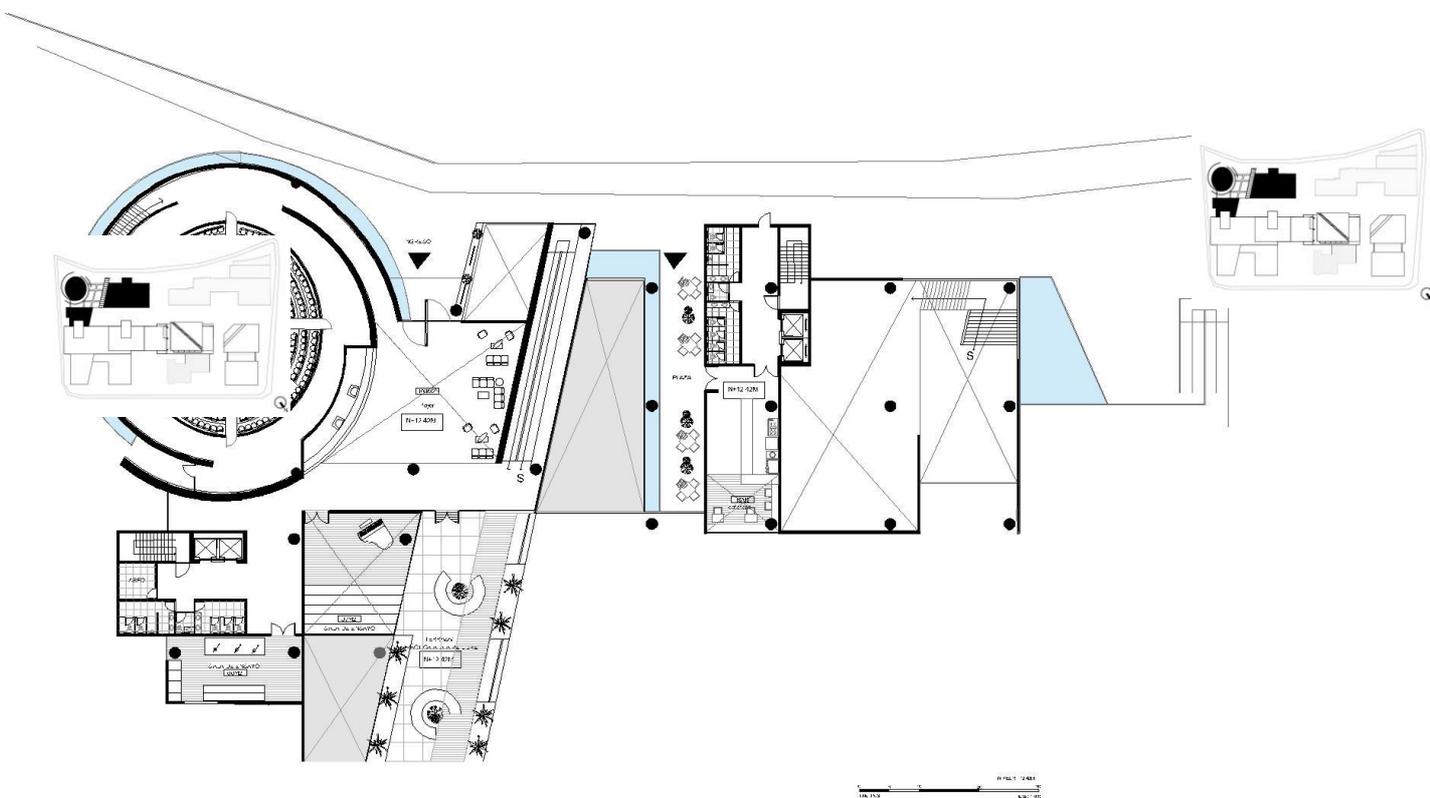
Planta segundo nivel. N+12.42m. Elaboración propia.
